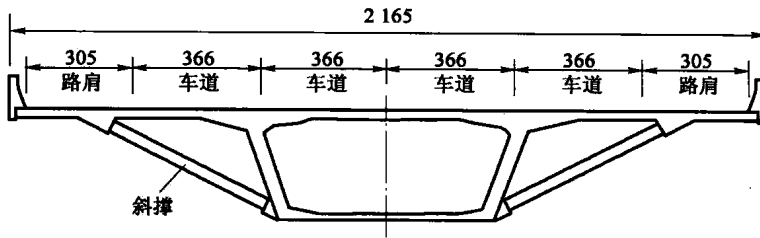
第三阶段的四车道箱梁结构断面示意图(尺寸单位:cm)
